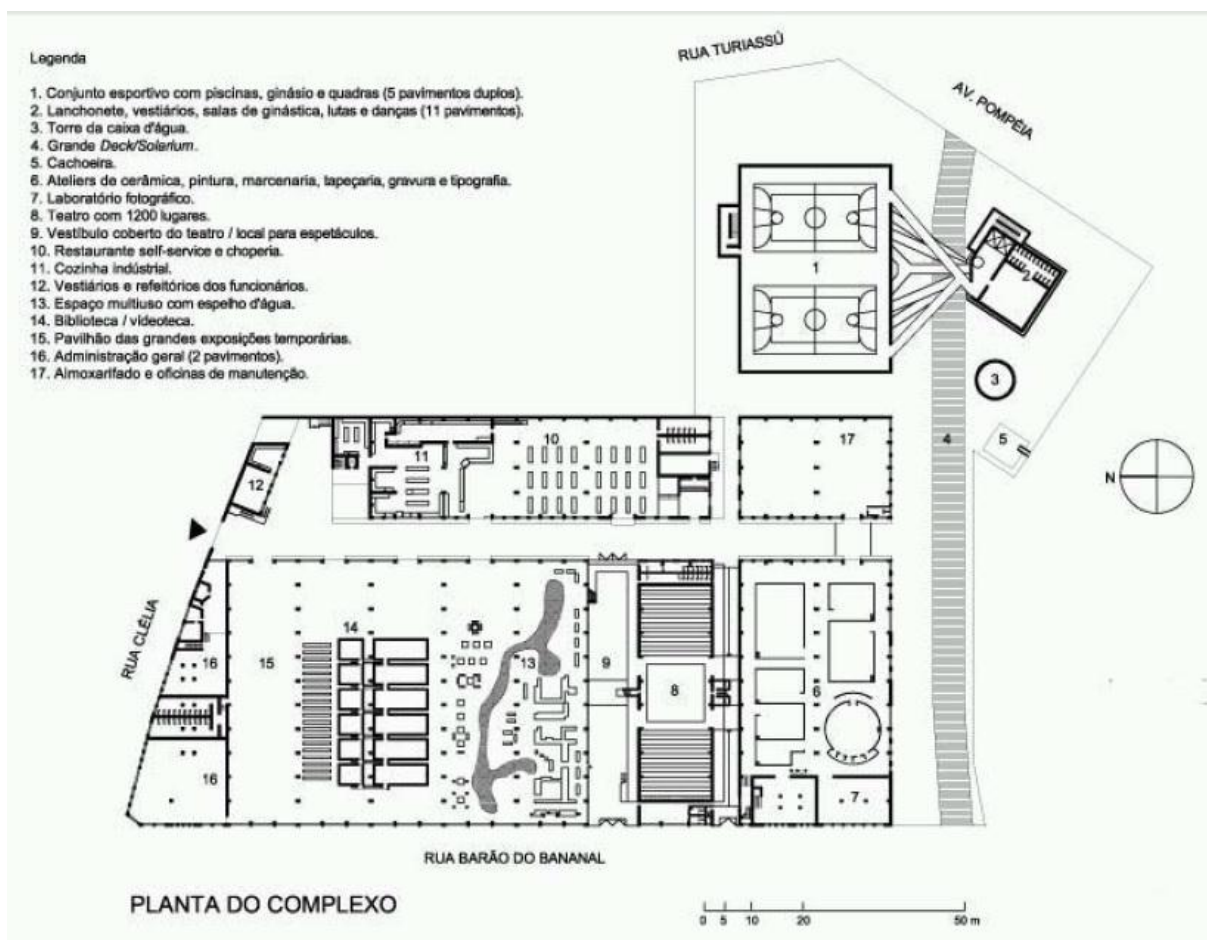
Planta do pavimento térreo. Fonte: (OLIVEIRA, 2007)
